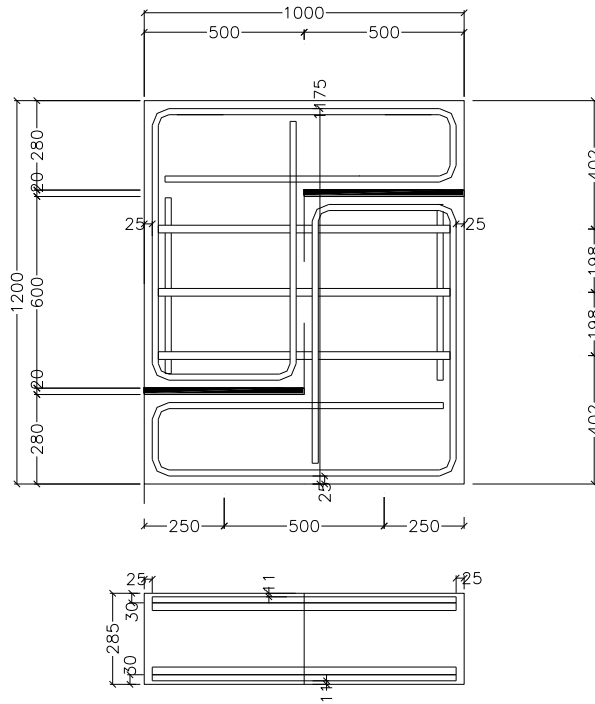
Croquis de las armaduras en el panel de control.
